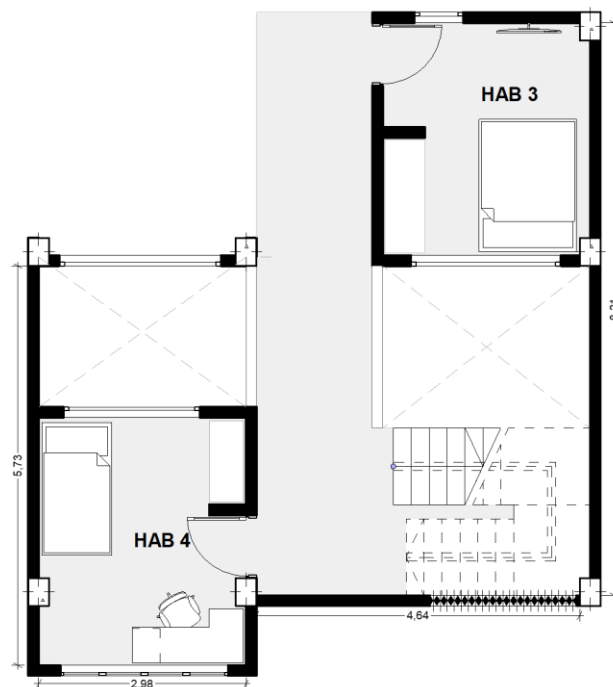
Propuesta arquitectónica área de proyección primera planta, segunda fase*Figura 45. *Propuesta arquitectónica área de proyección segunda planta, primera fase
